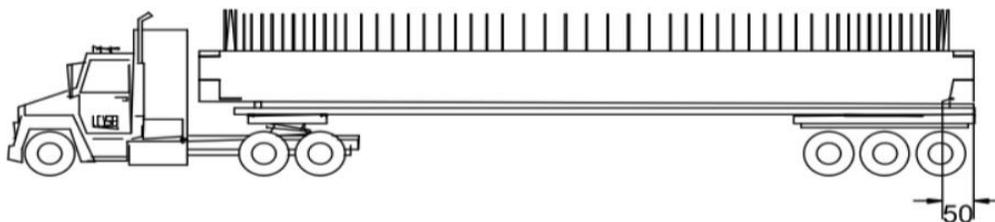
Instrucciones del área de ingeniería para el traslado de planta de fabricación a obra.
